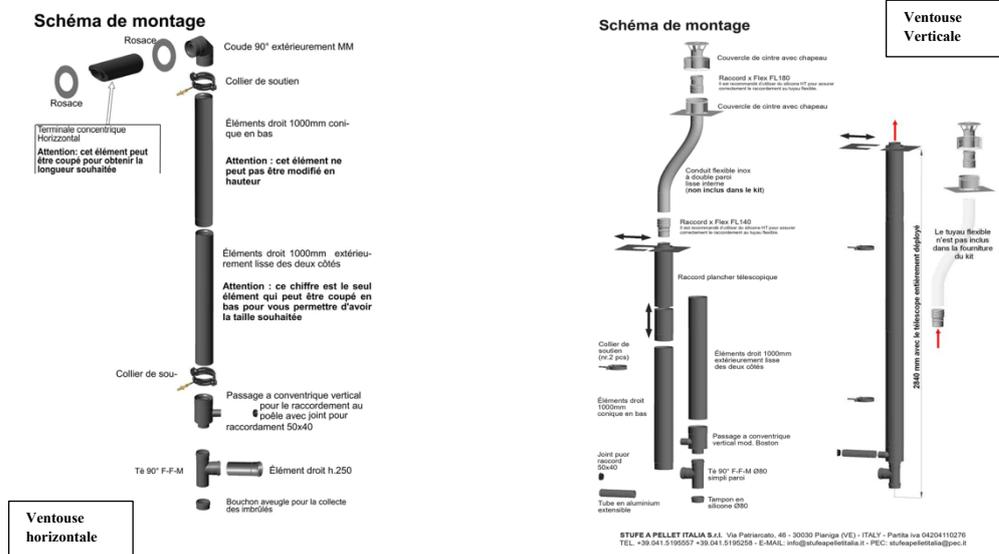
Conduits ventouses double -flux pour installation avec poêle étanche en Zone 3 ou Zone 2
